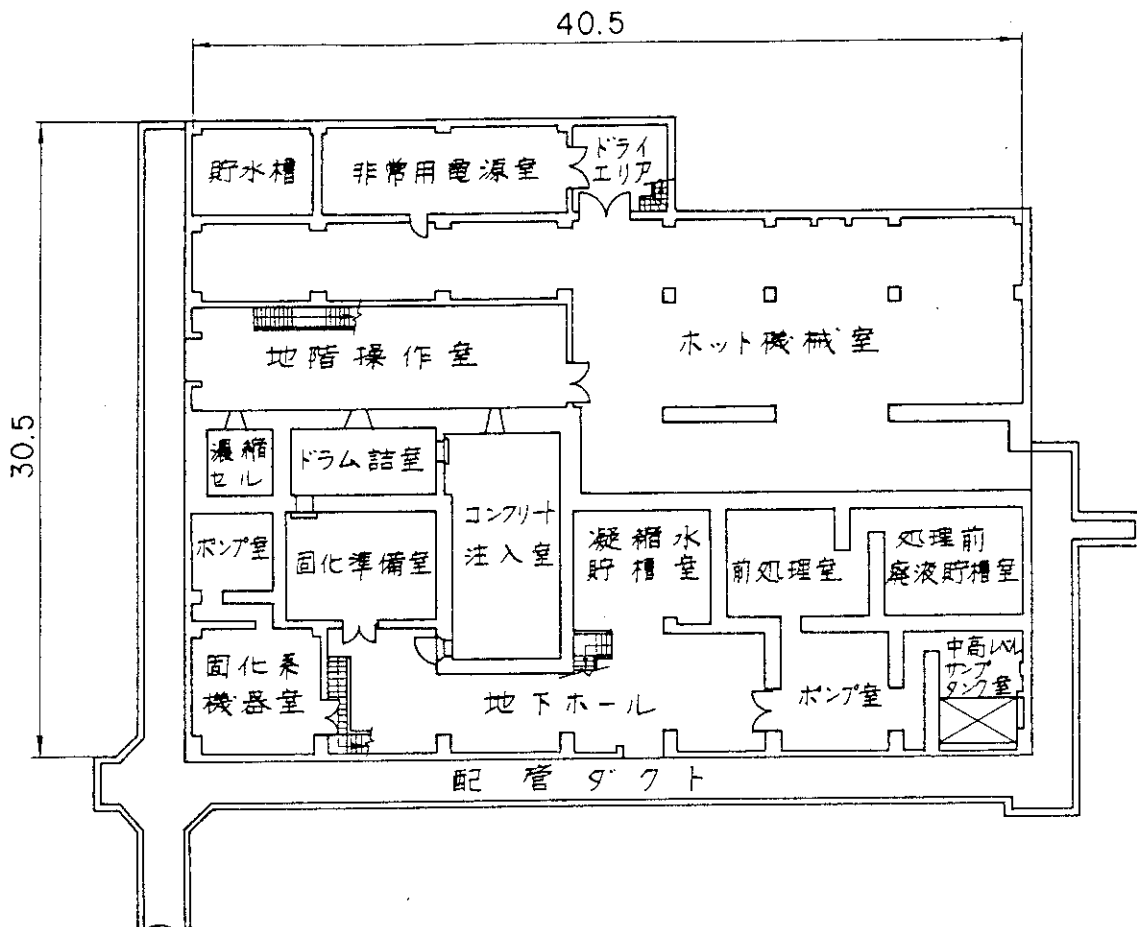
第2廃棄物処理棟地階平面図 (単位:m)
